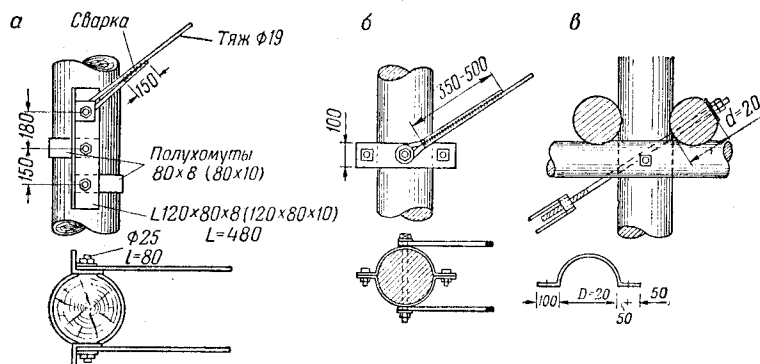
Детали прикрепления металлических тяжей к сваям:
